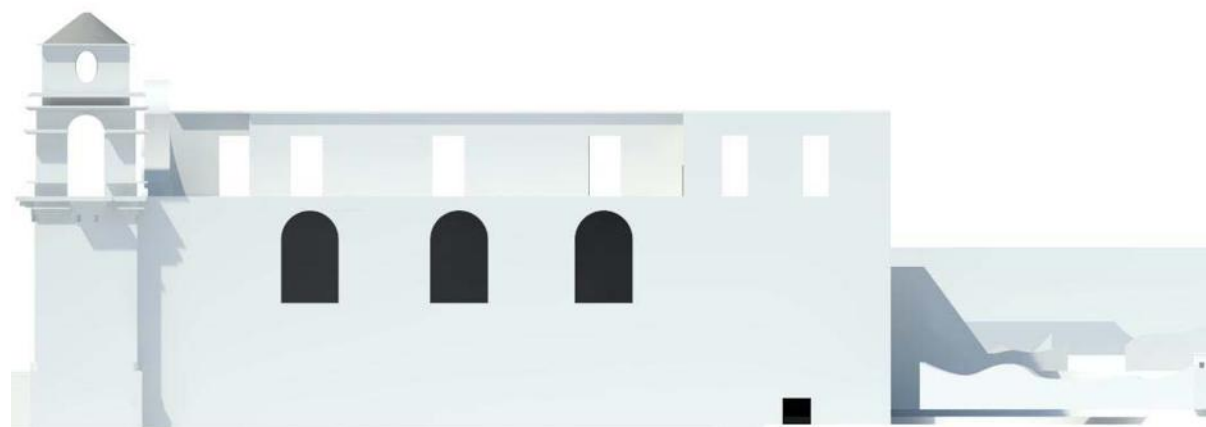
Fachada norte del casco de la ex hacienda de Santa Rita, cuerpo de la capilla y torre. MCHB.
